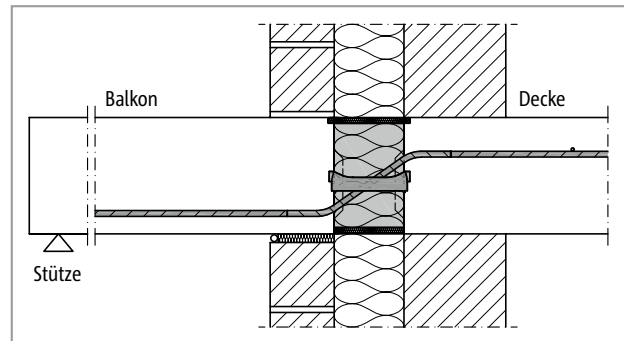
Schöck Isokorb® XT Typ Q: REI 120 in zweischaligem Mauerwerk
